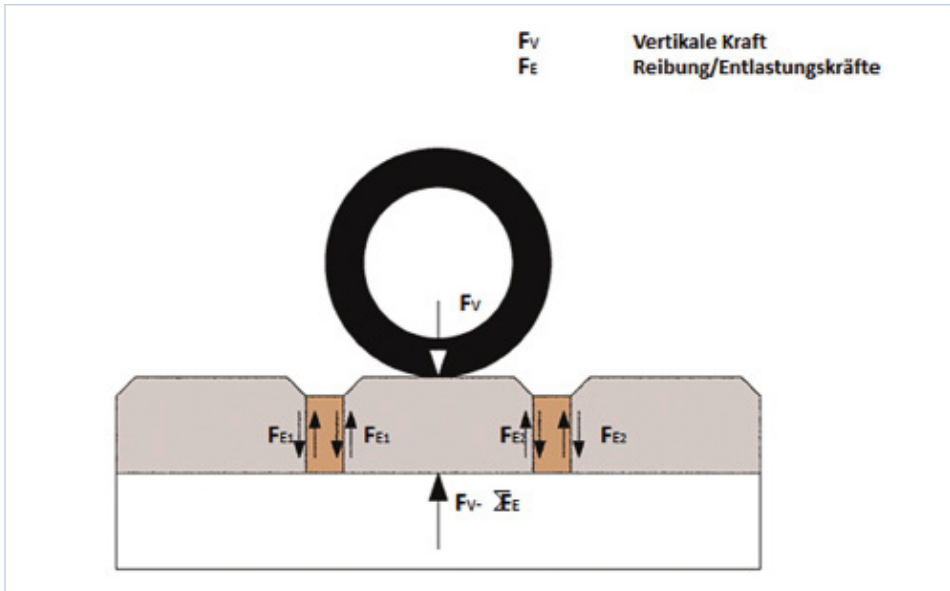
Pflasterfläche mit stehender Radlast (vertikale Kraft) [Quelle: Buchholz]
